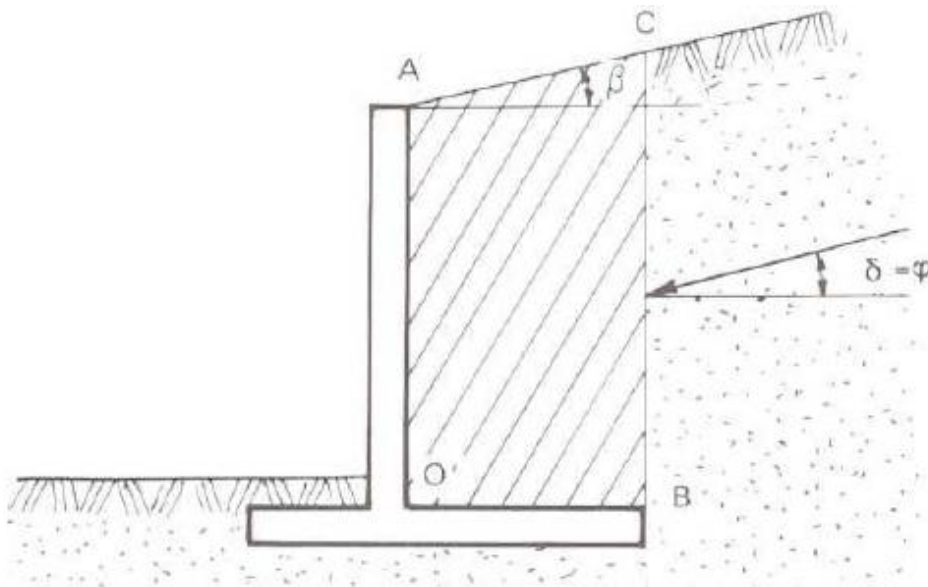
Calcul de la poussée suivant le plan fictif BC
